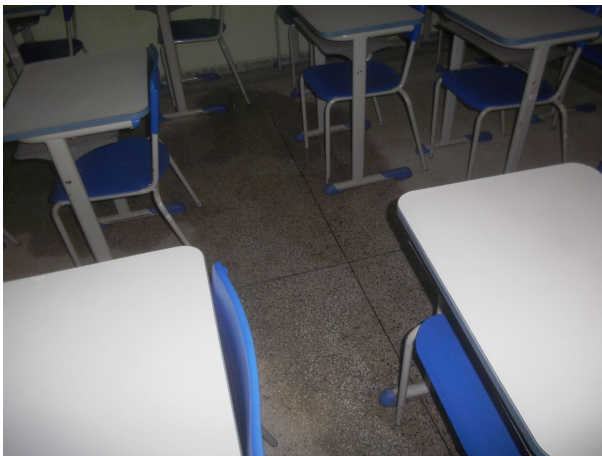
Empoçamento no piso das salas de aula – 1º Pavimento (07/05/2018).
